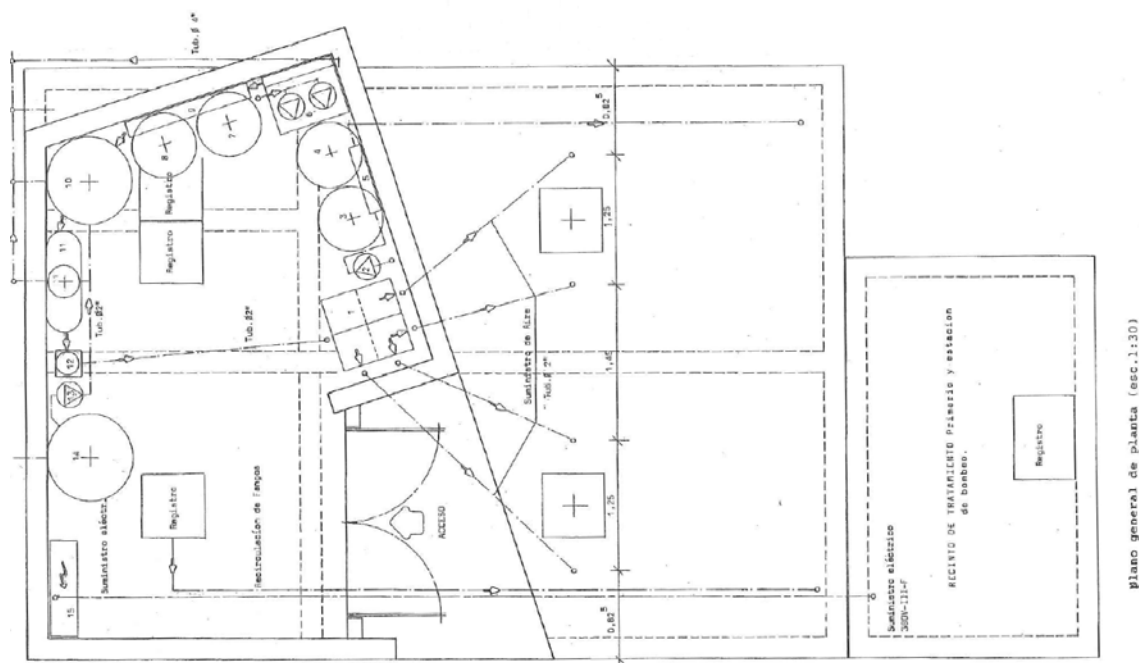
Plànol en planta de la depuradora de Marc Pastor.
